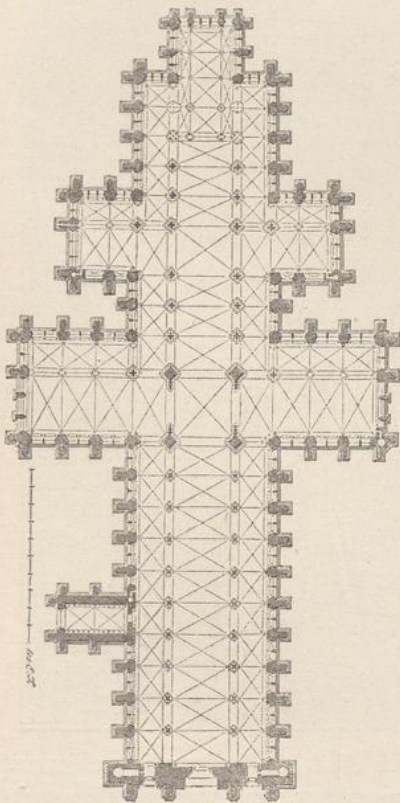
Kathedrale zu Salisbury. Grundriß.
